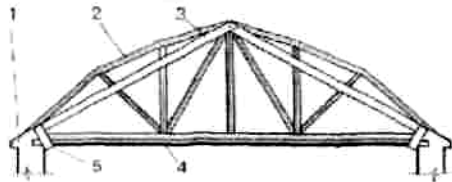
Схема підсилення дерев'яної ферми перетворенням на тришарнірну арку: 1 – існуючі конструкції; 2 – ферма, що підсилюється; 3 – елемент арки підсилення; 4 – металева затяжка; 5 – накладка
